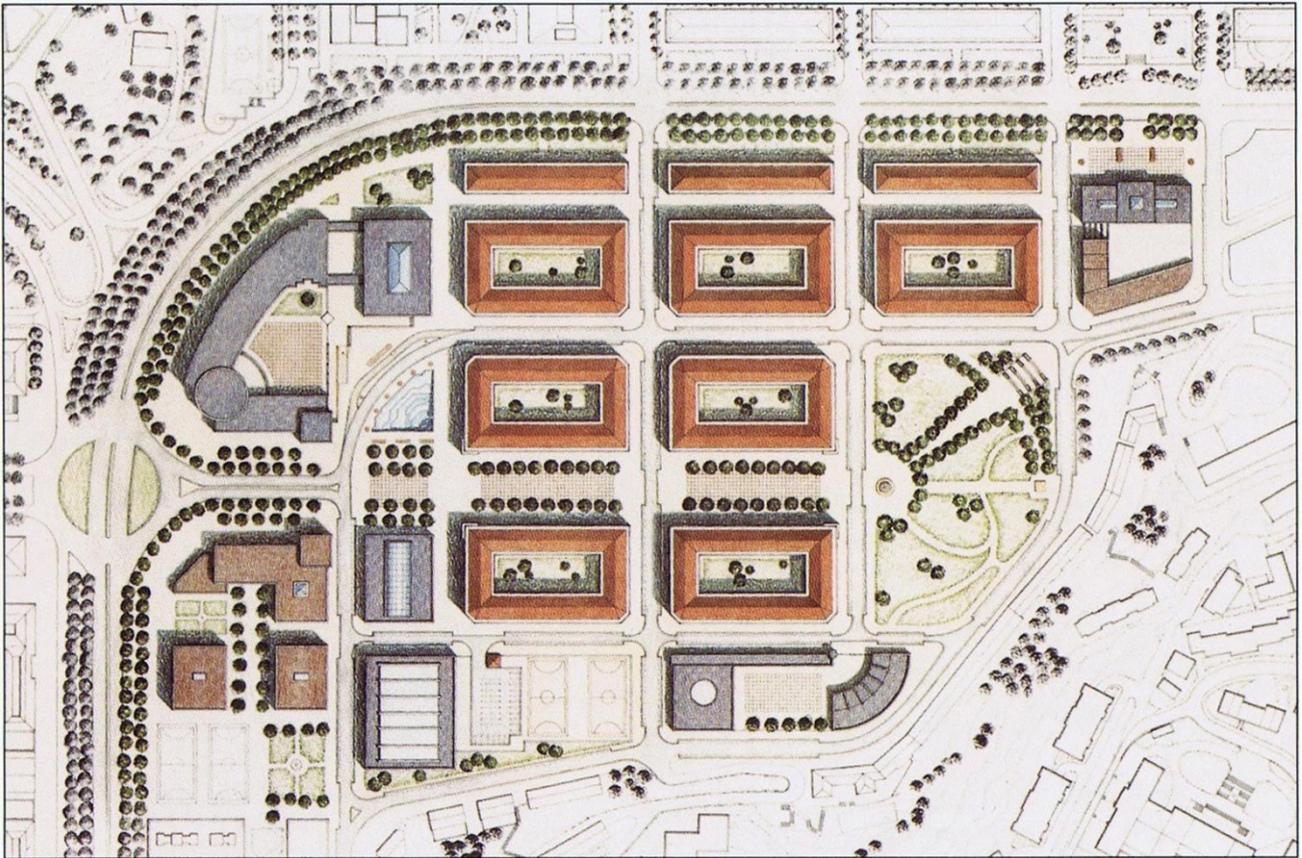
Plano de la primera propuesta de ordenación de la Oficina del Plan General - P.P.O.P.G.
